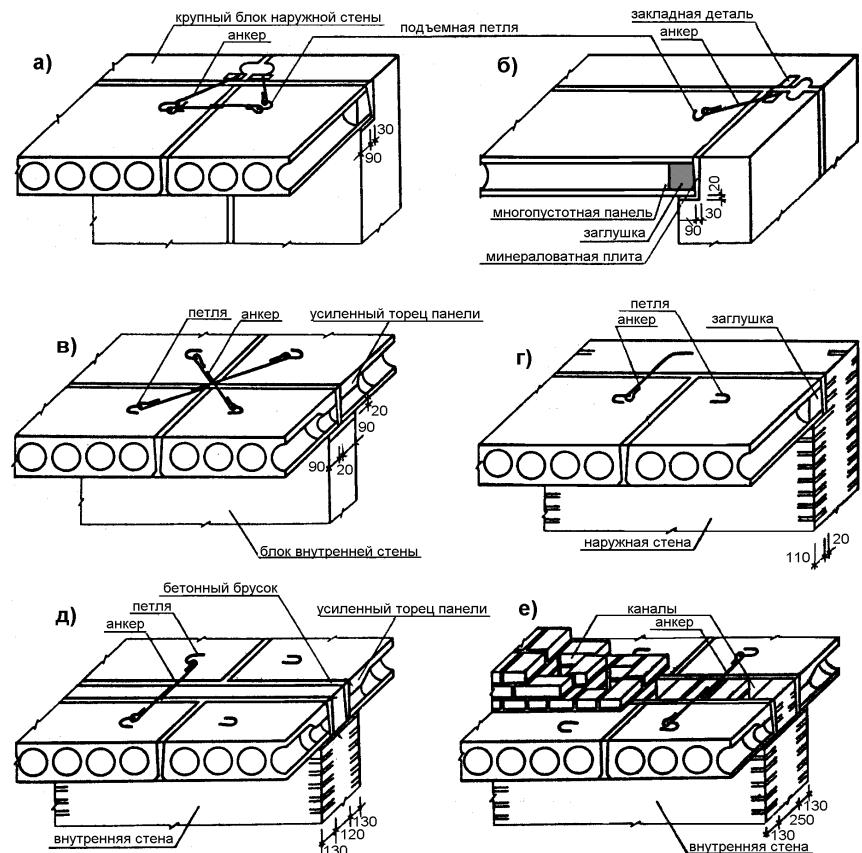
Опирание многогустотных панелей перекрытия на кирпичные и крупноблочные стены.
